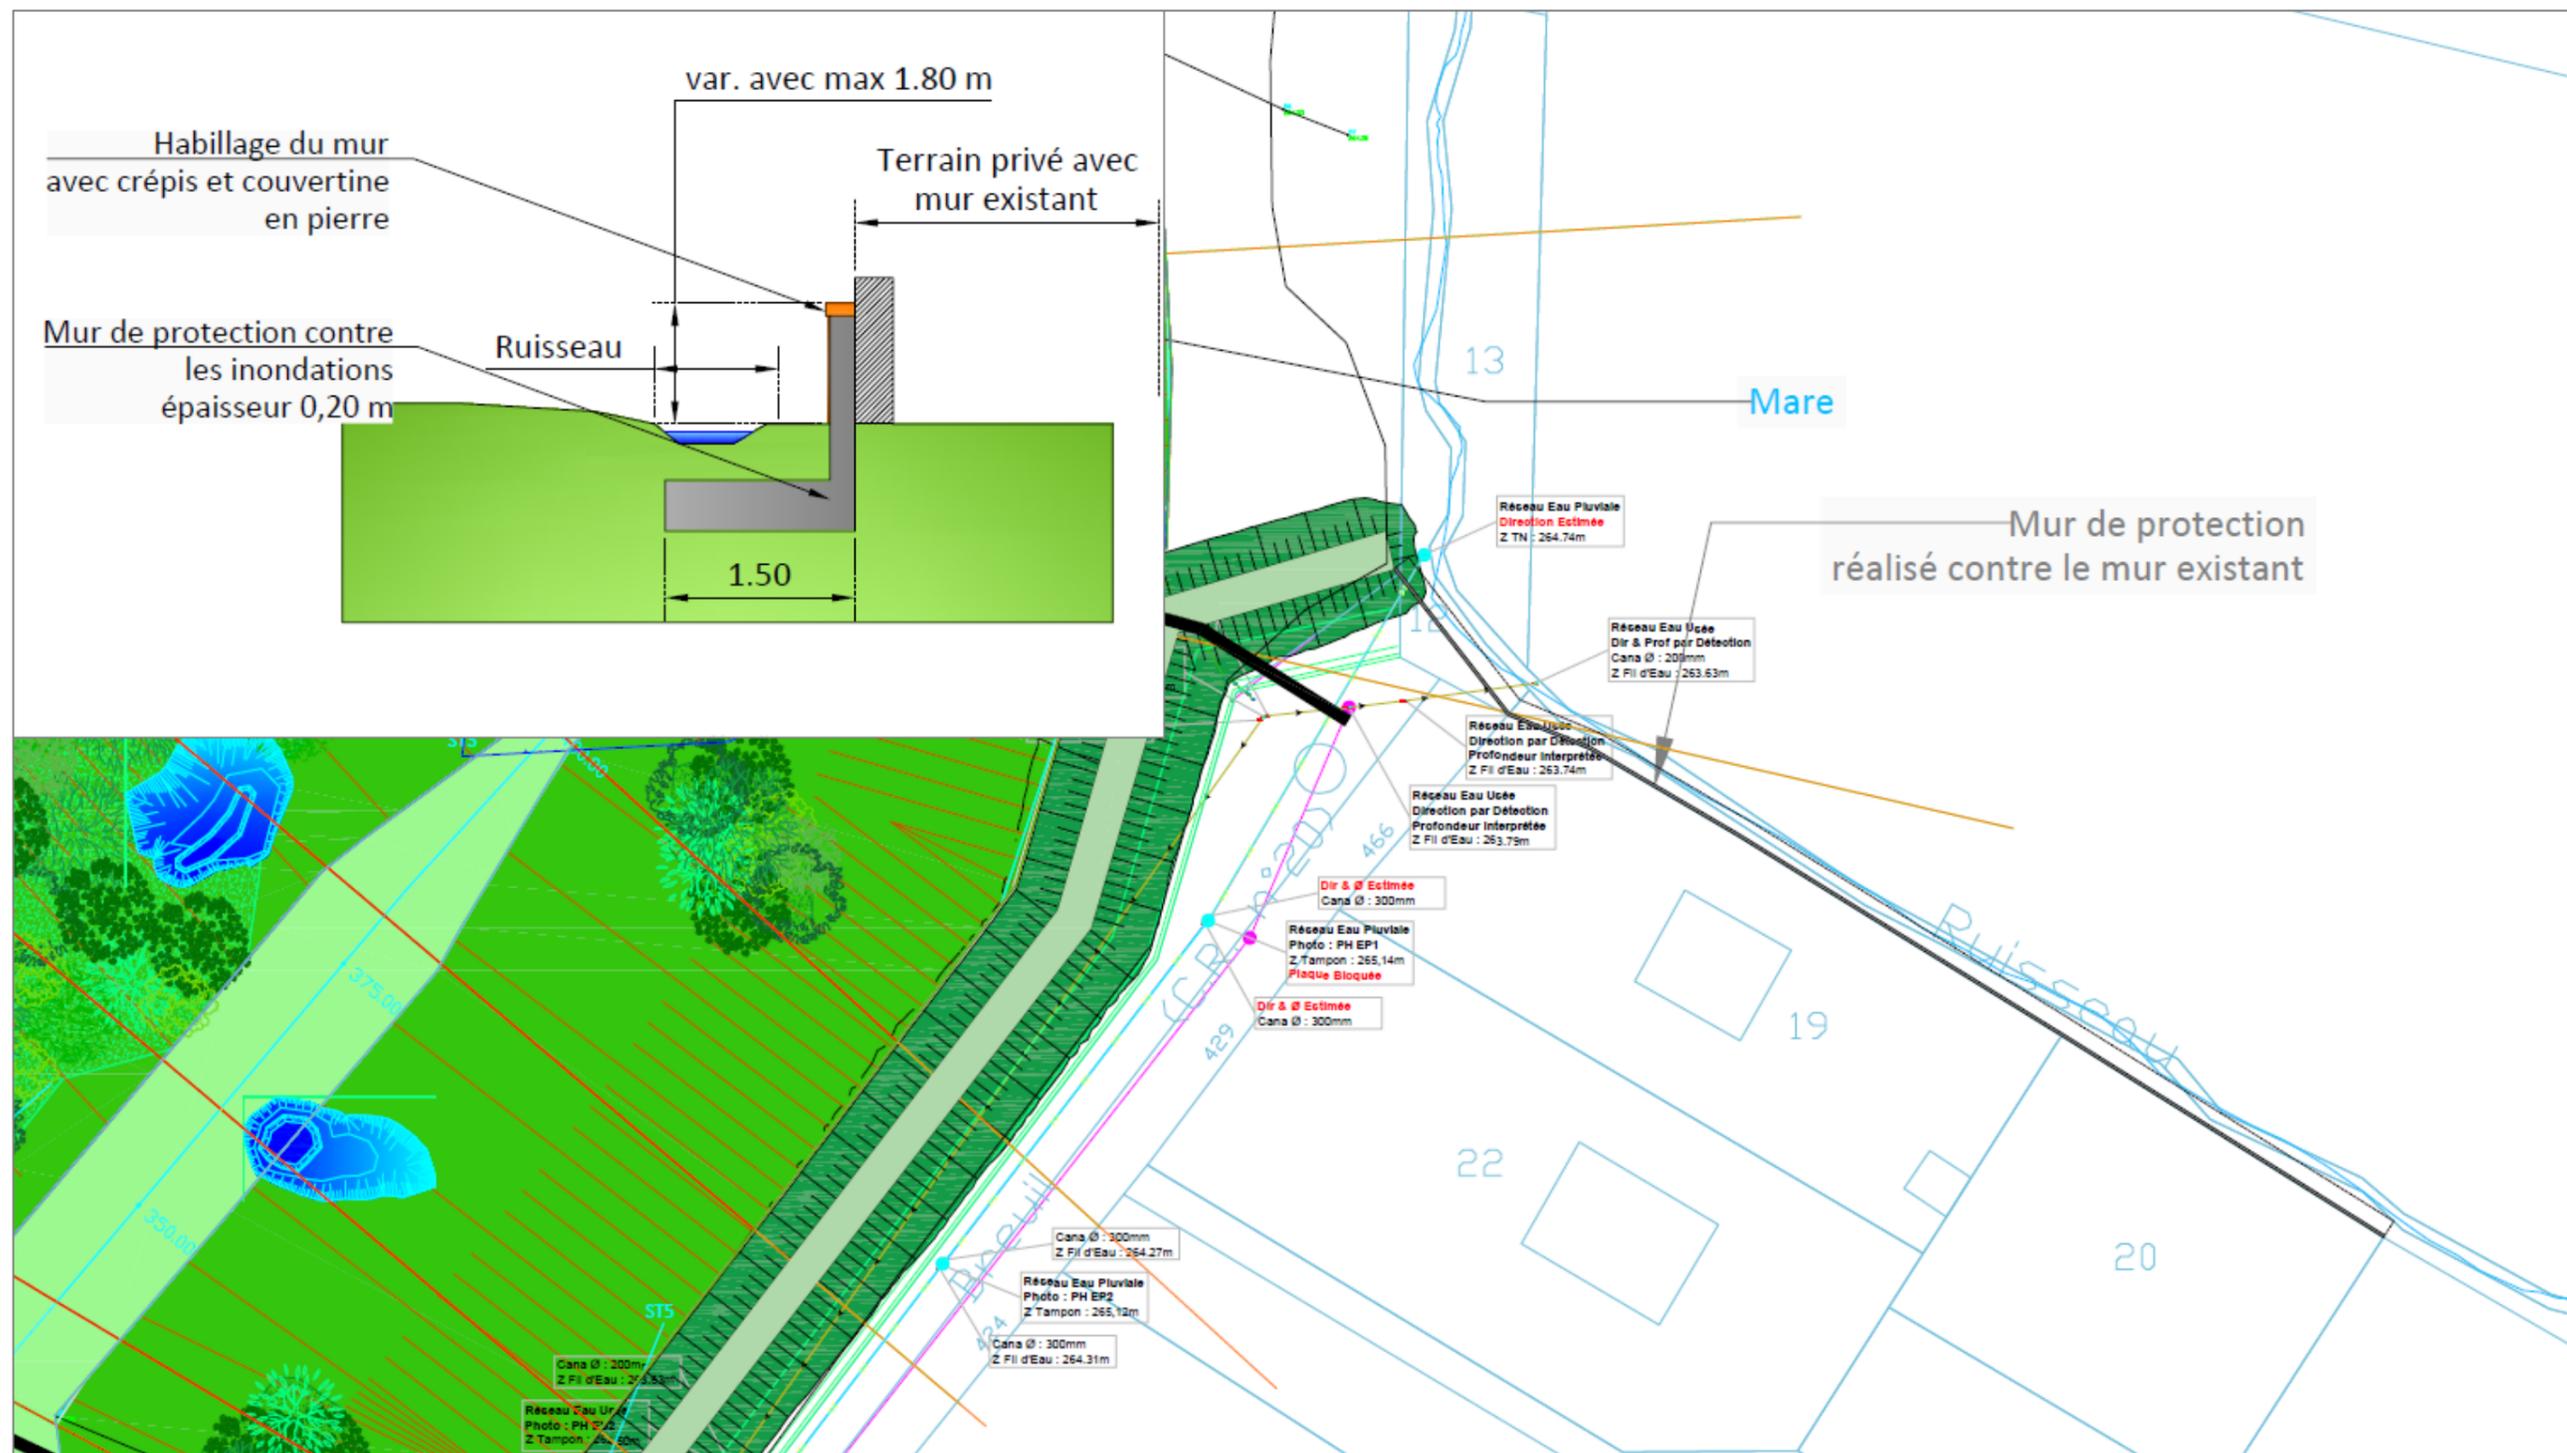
Opération 4 - action 7.5 : Mur de protection – Vue en plan et profil en travers des aménagements
